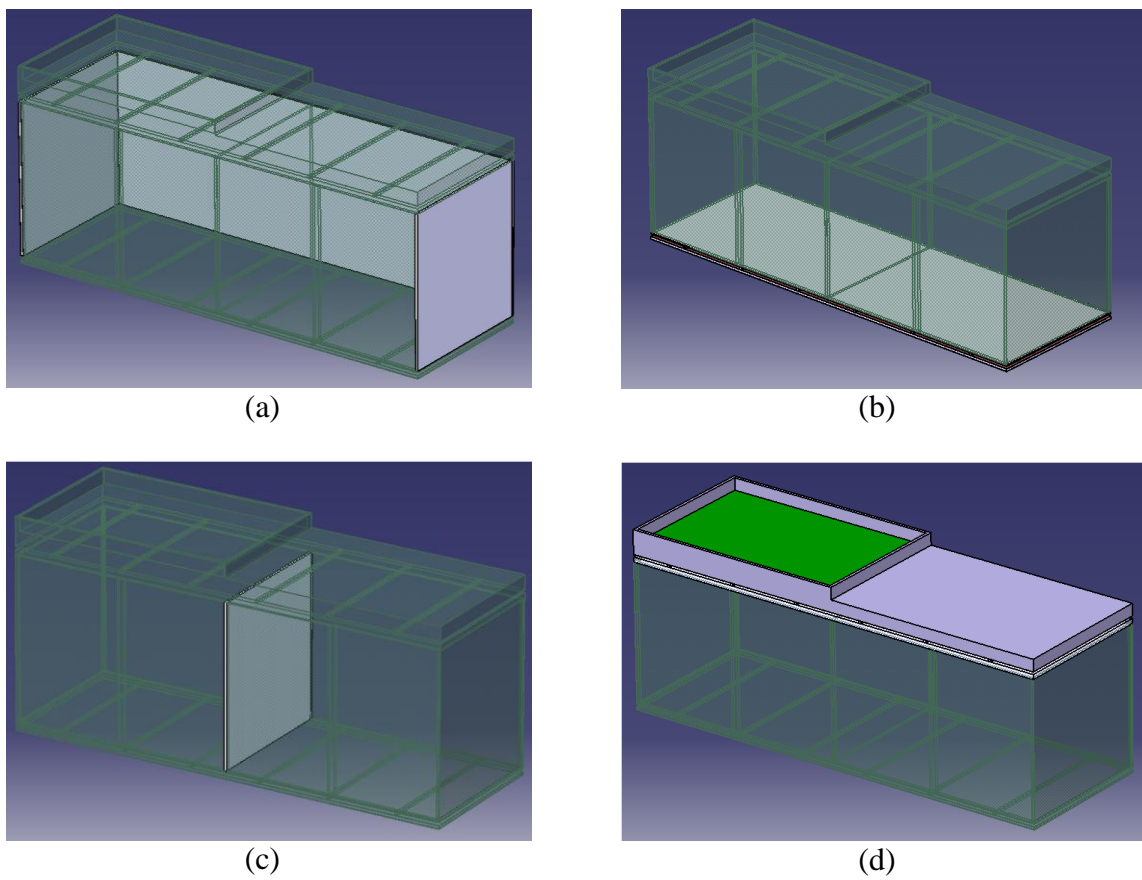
Esquemas realçando os elementos construtivos (a) Elementos de fachada (N, E, O) (b) Pavimento sobre o exterior (c) Fachada divisória (d) Cobertura exterior
